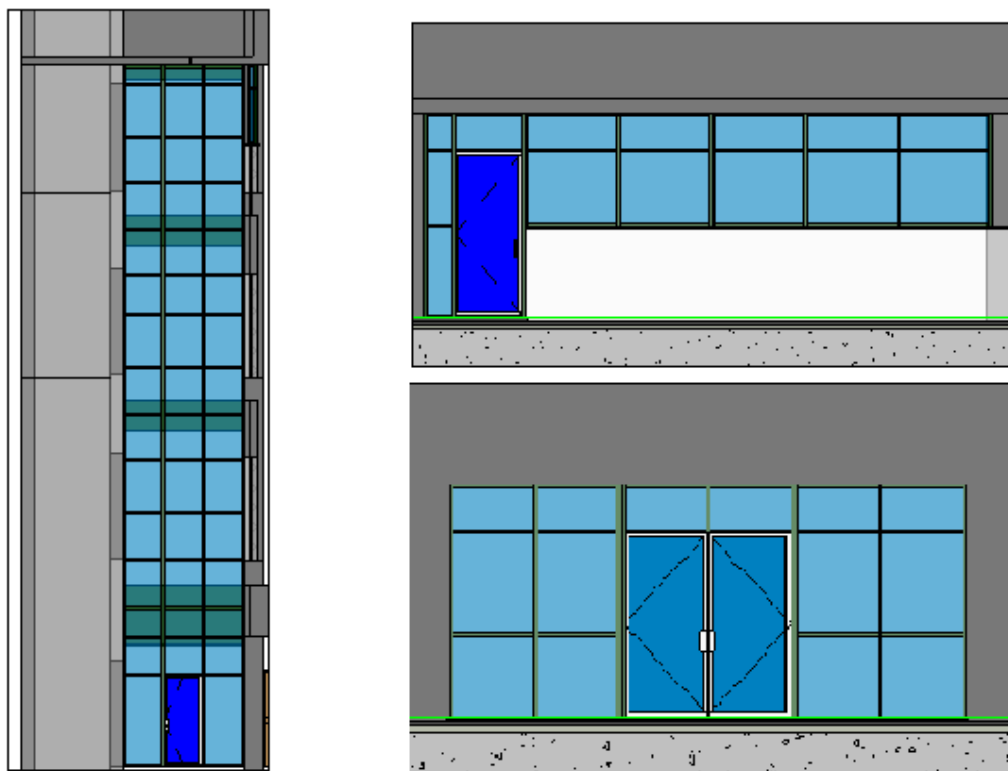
Curtain Wall das diversas janelas do caso de estudo.
